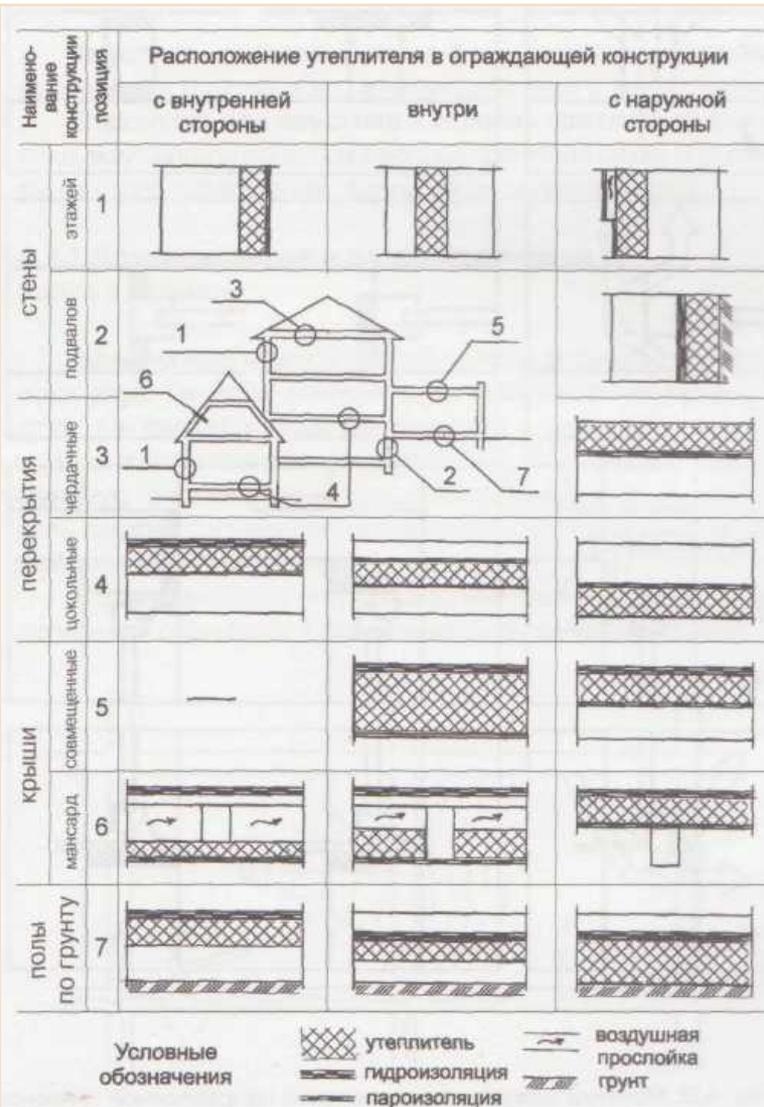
Расположение утеплителя, пароизоляции и гидроизоляции в наружных ограждениях
